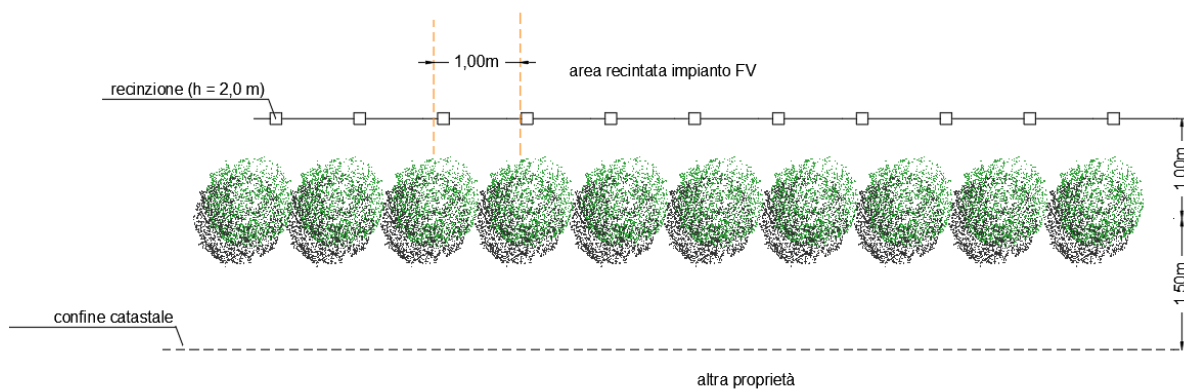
Siepe polispecifica - planimetria di progetto.
